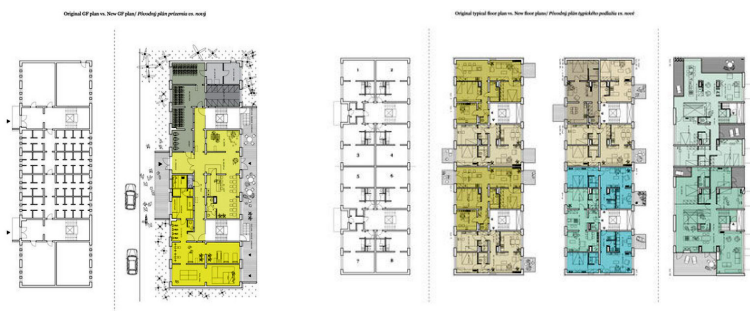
Проект перепланировки этажей жилого дома *Prefab House*.
